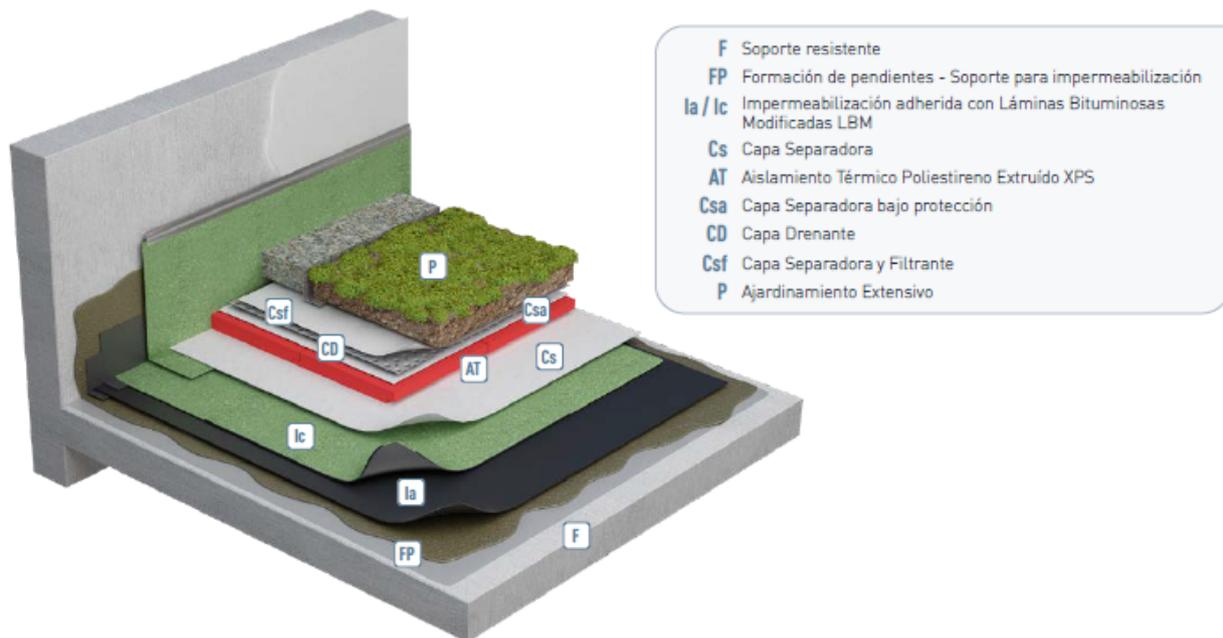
Sistema de cubierta plana ajardinada convencional
